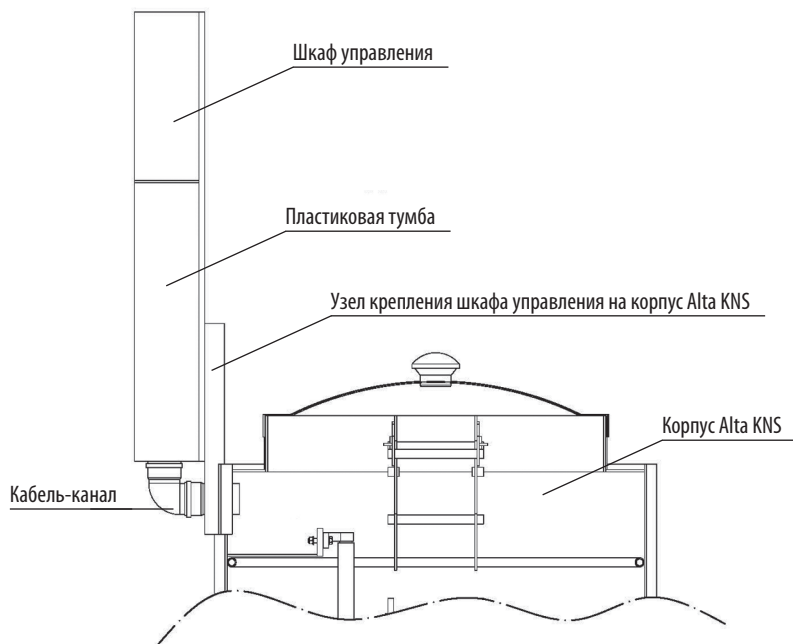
Схема установки шкафа управления на корпус Alta KNS
